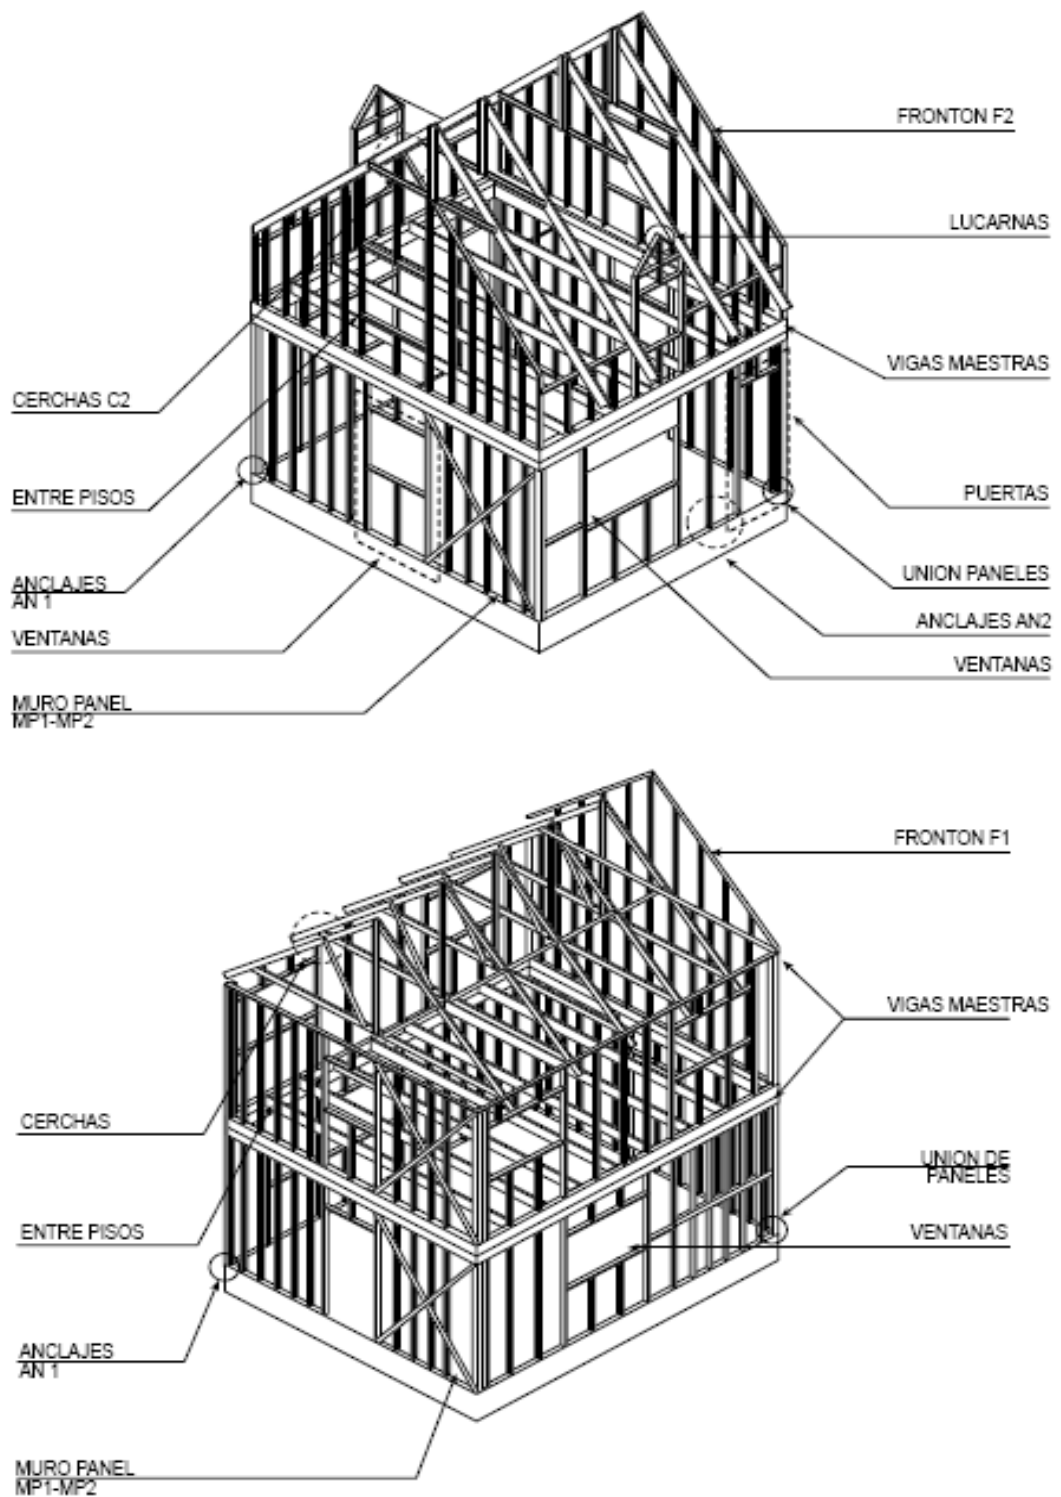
Esquema general de tipologías de vivienda estructurada con perfiles metálicos livianos.
